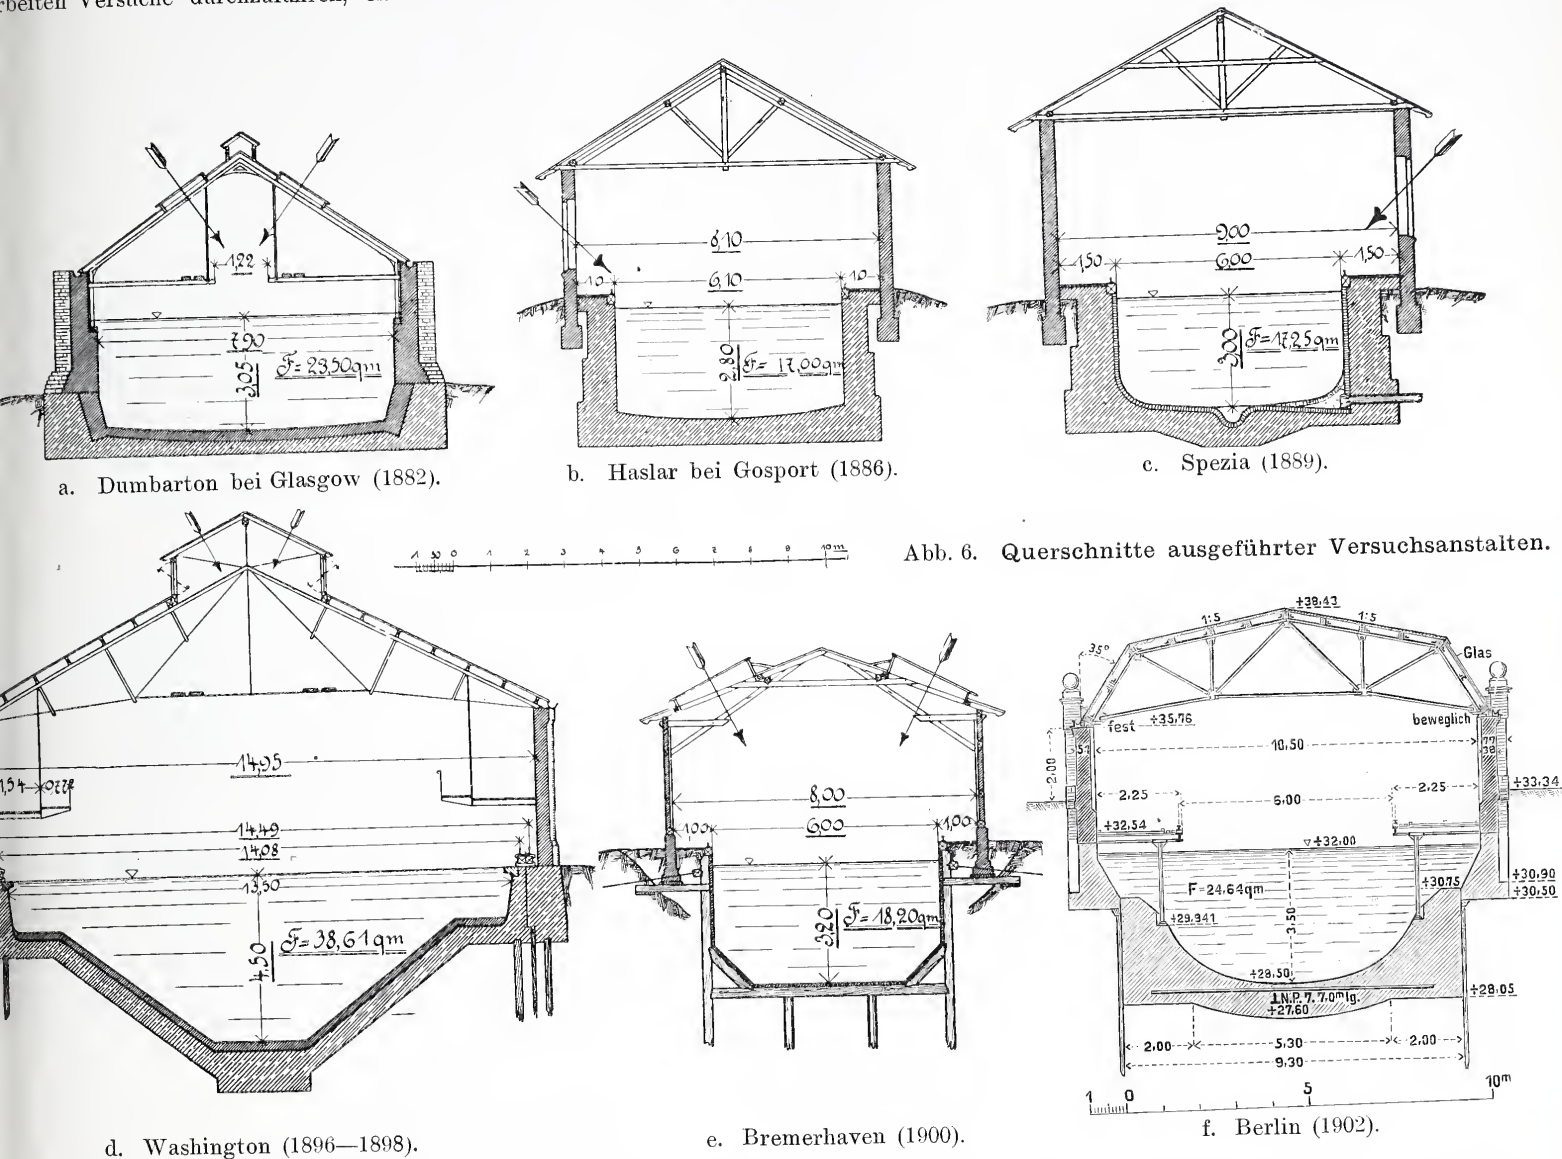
Querschnitte ausgeführter Versuchsanstalten.
